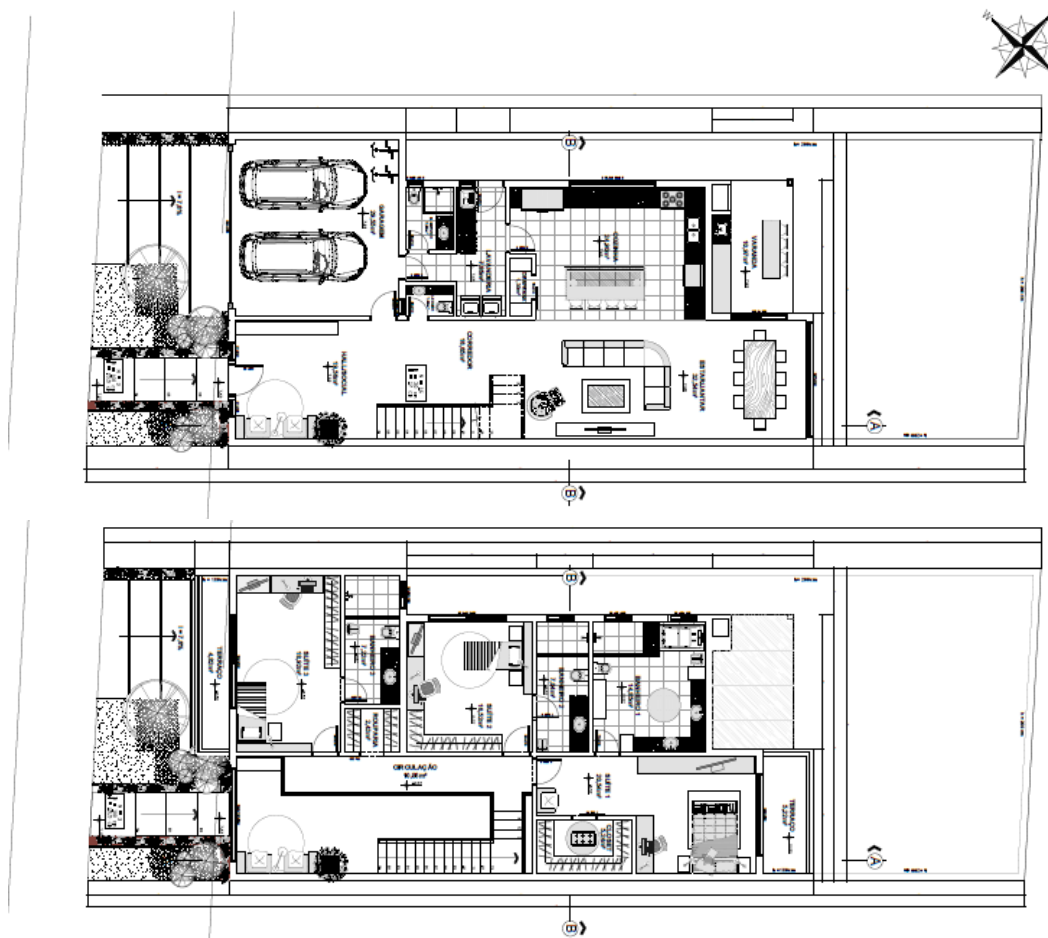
Planta baixa do térreo e do 2º pavimento do projeto arquitetônico estudado.
